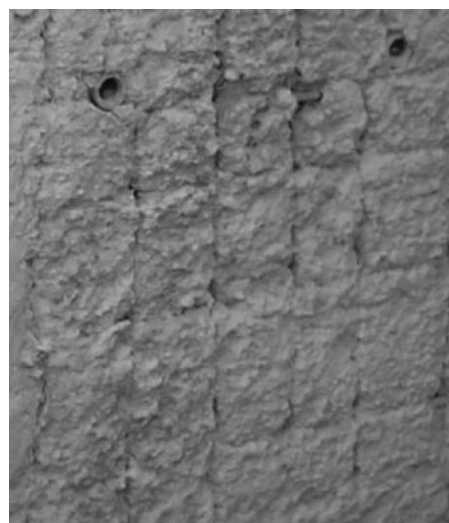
Betonierfehlstellen an der Bewehrung im Bereich der Betondeckung einer Schlitzwand [20] (Quelle: EFFC & DFI)
